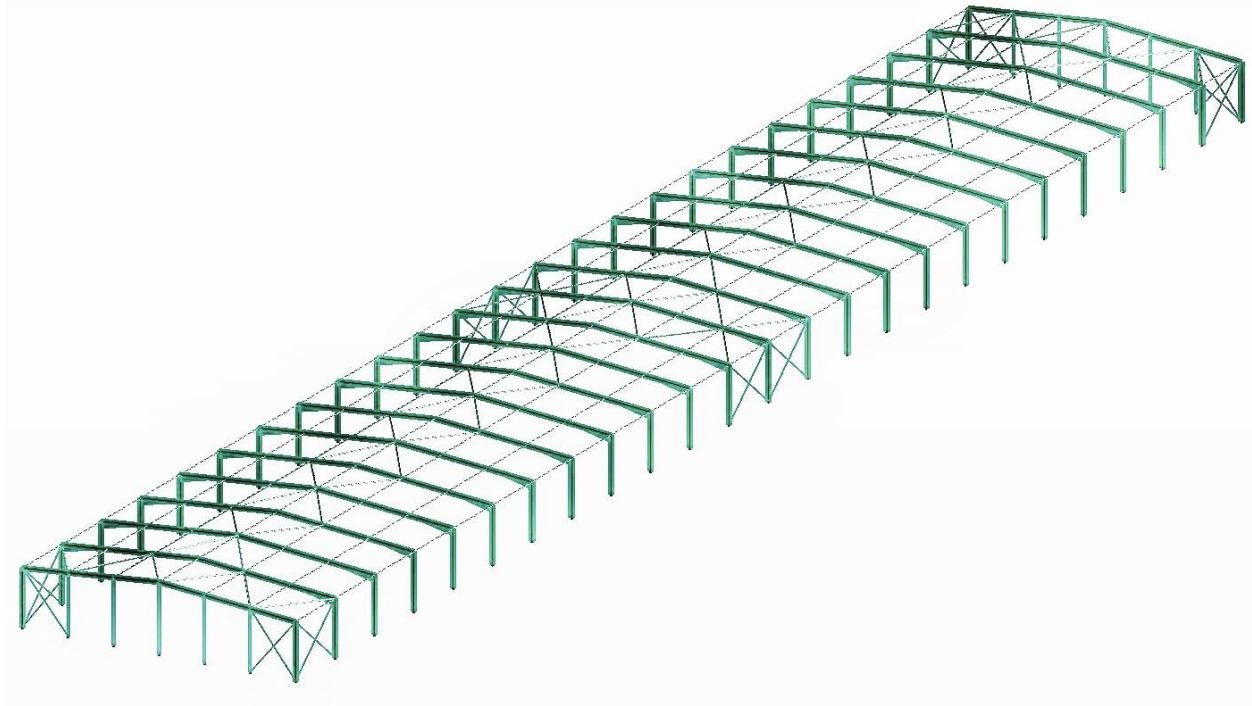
Esquema estrutural do pavilhão industrial metálico 3D
